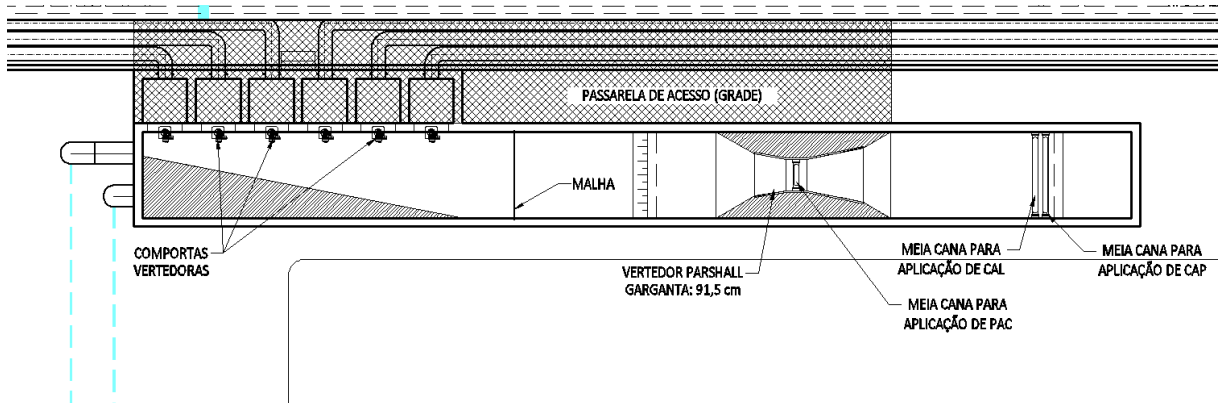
Esquema em planta da unidade de mistura rápida
